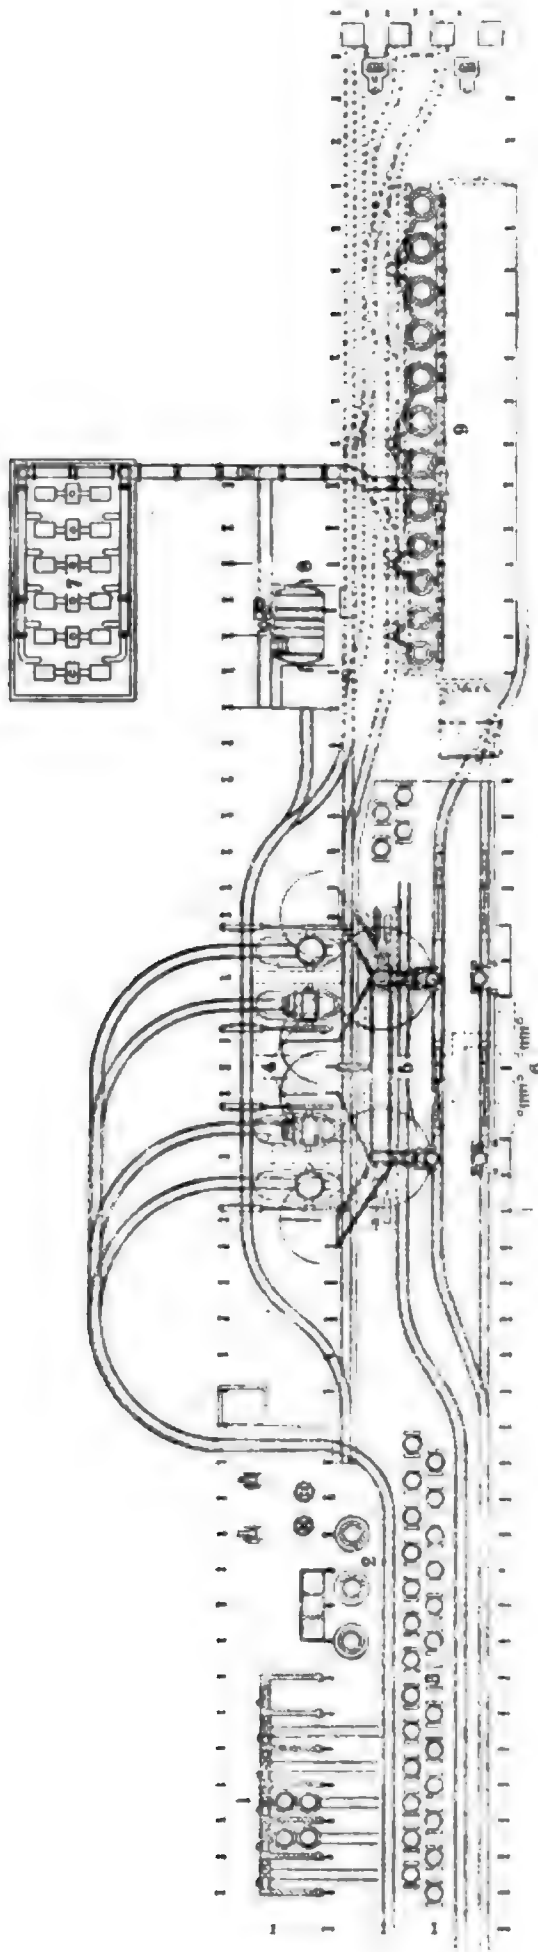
Lageplan des Bessemerstahlwerks der Lackawanna Steel Co.
